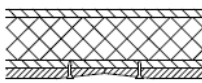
Fijación de placas de yeso laminado sobre el panel WALL.
